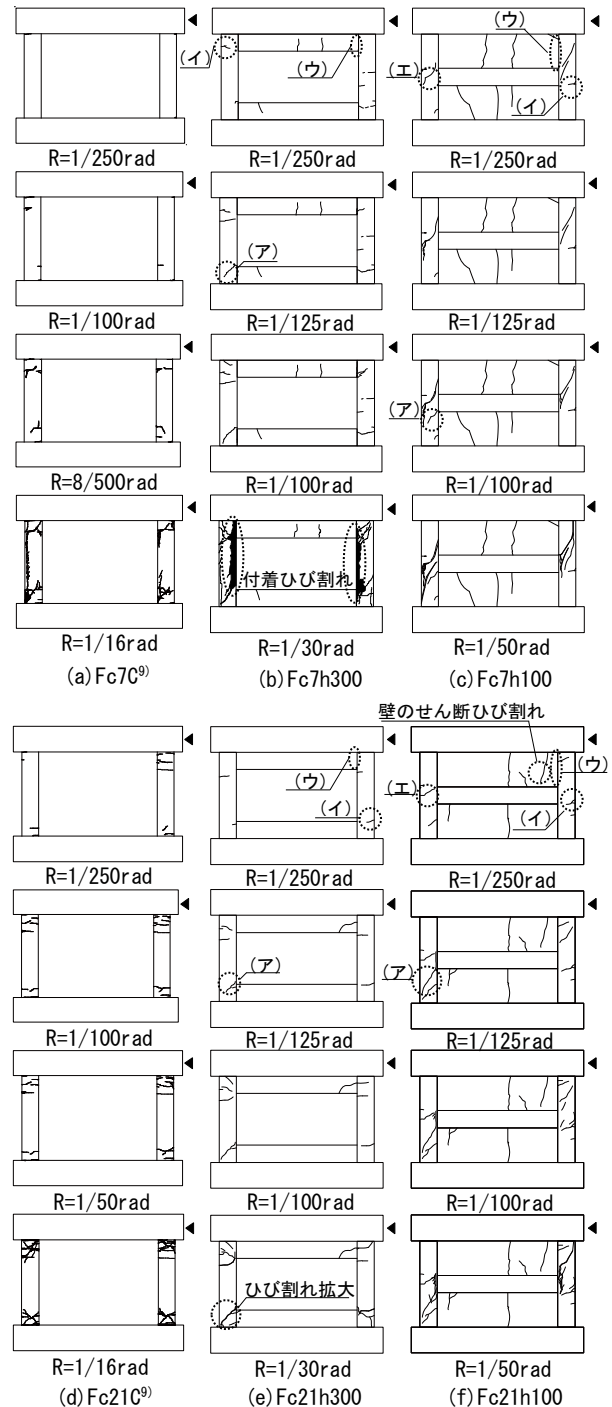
各変形段階におけるひび割れ状況図 (◀: 加力方向)
